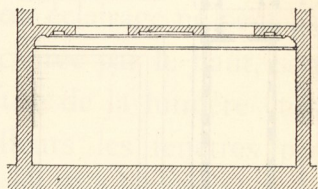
Vitrage en plafond d'une salle de grande largeur.
